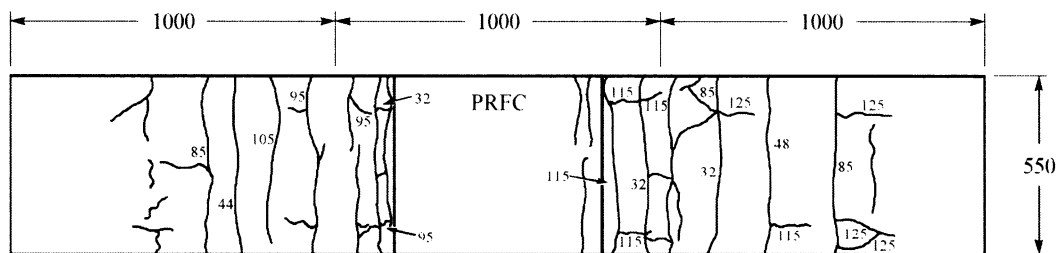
Vue de la poutre C2 du côté des barres inférieures à la rupture.
